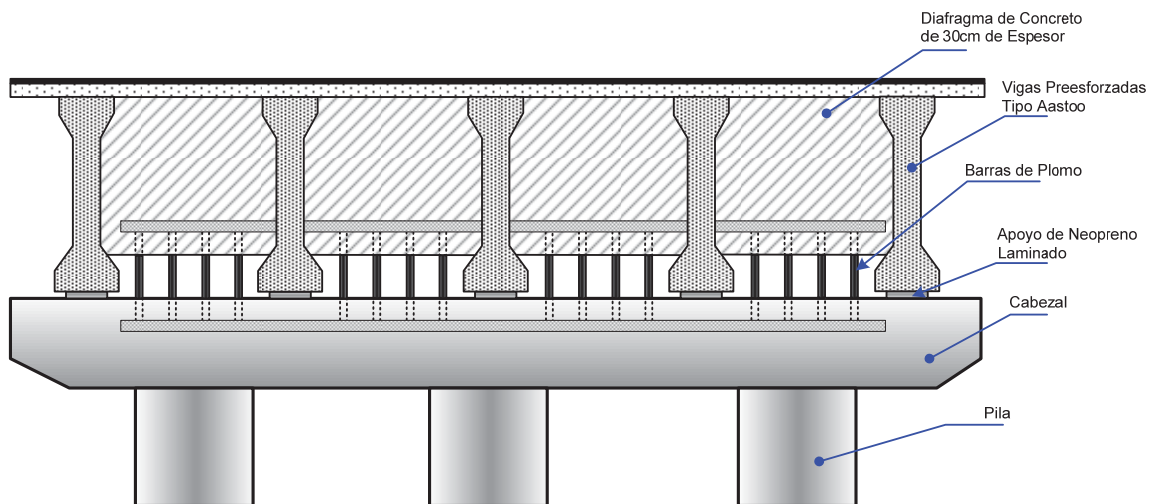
Sistema Aislador-Disipador con Barras de Plomo o de Acero
